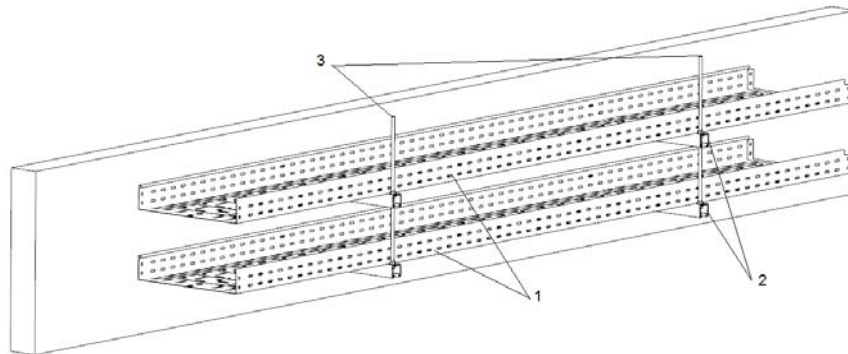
Общий вид подвеса к стене со шпилькой к потолку (вариант 4).
